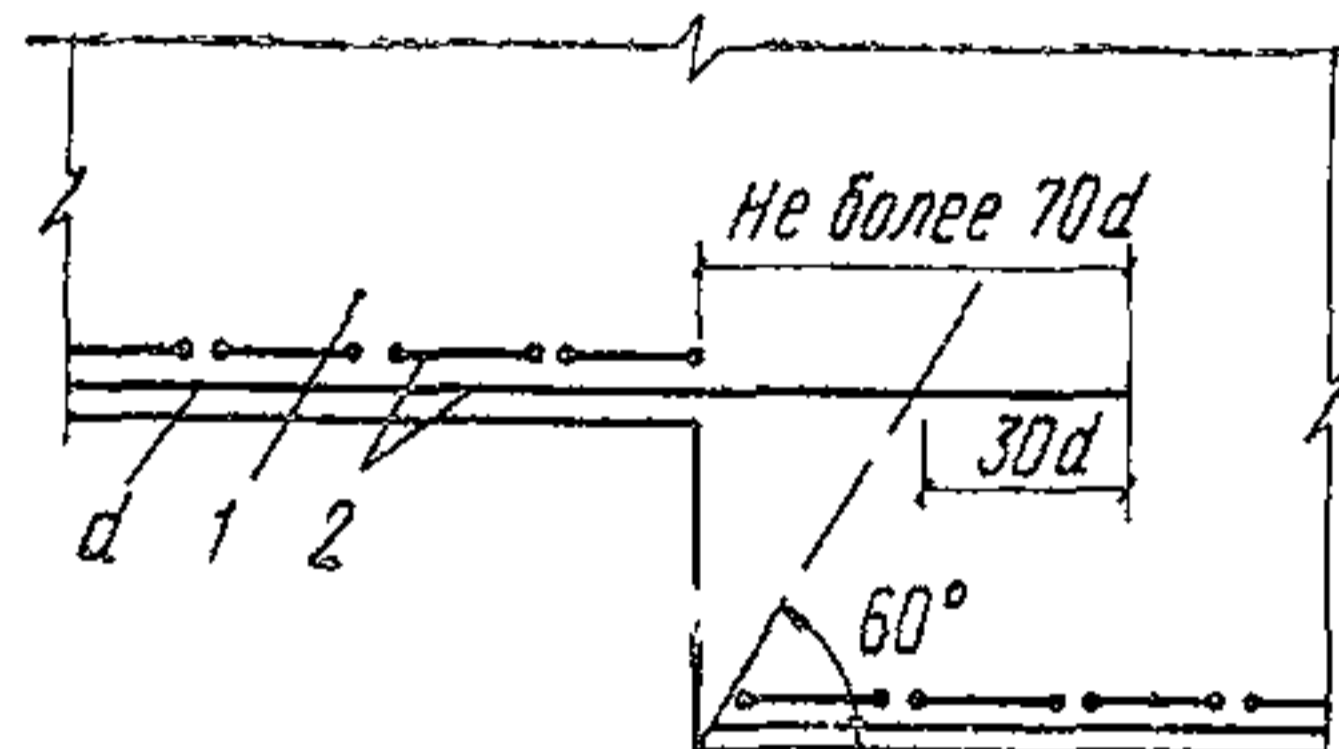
Армирование фундаментов оборудования при перепаде отметок подошвы фундамента
